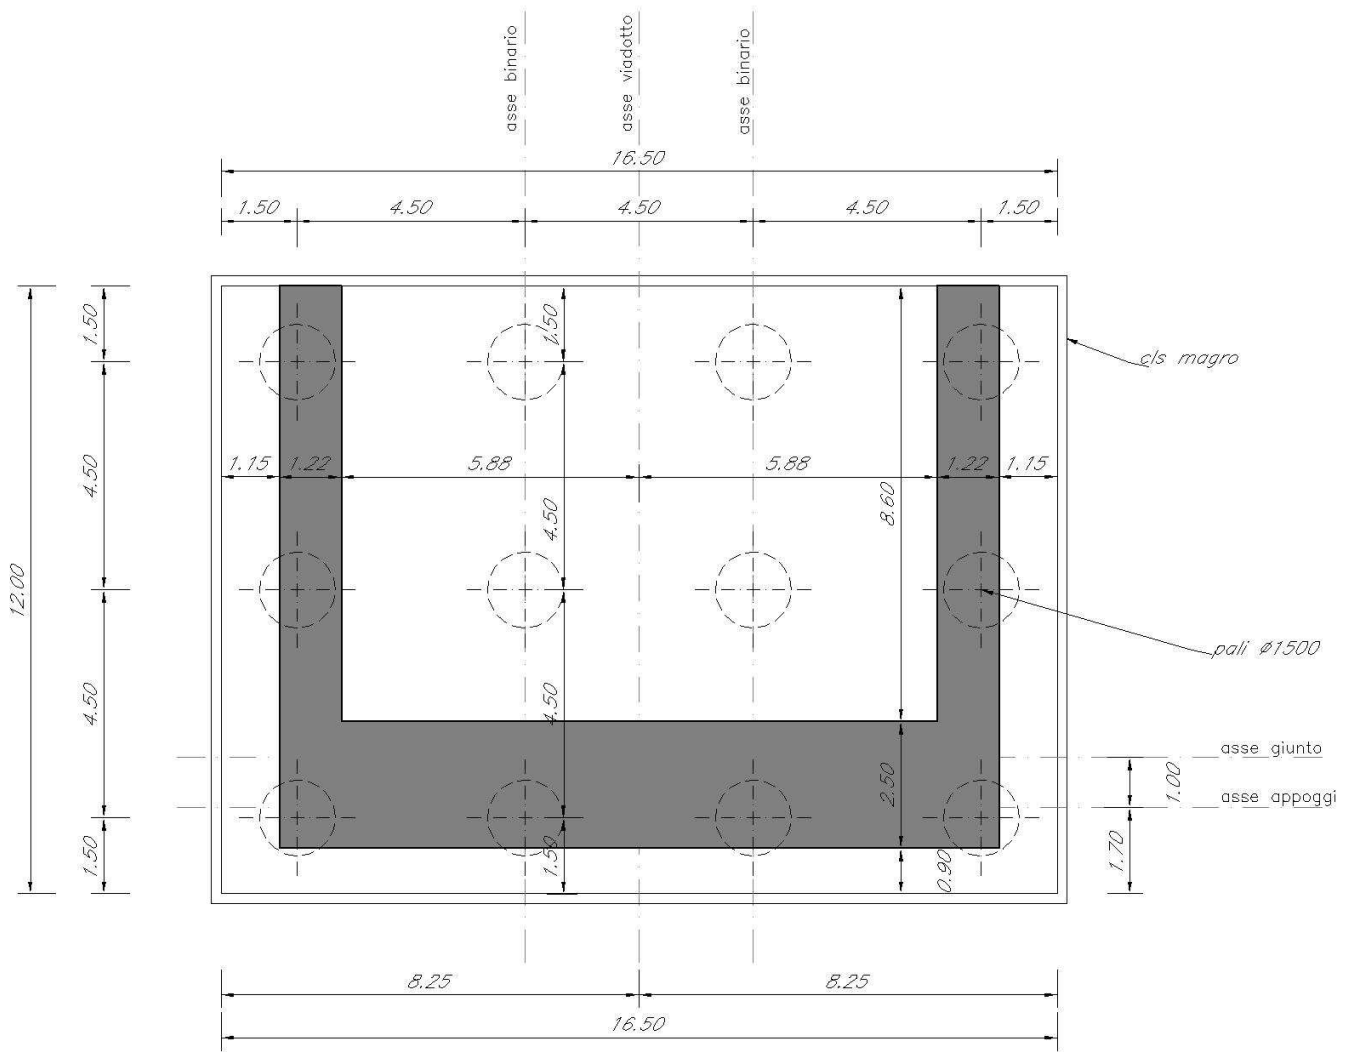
Pianta fondazioni della spalla tipo.
